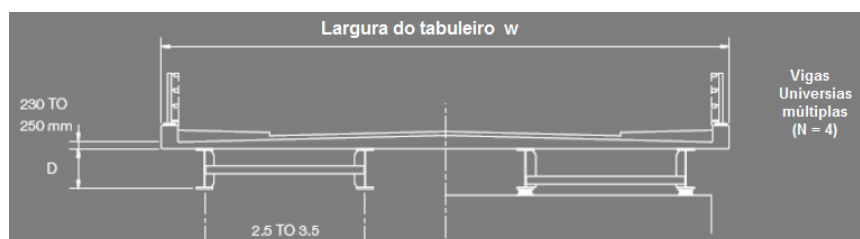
Esquema tipo de uma secção transversal constituída por quatro vigas universais (Hayward, A. 2005).
